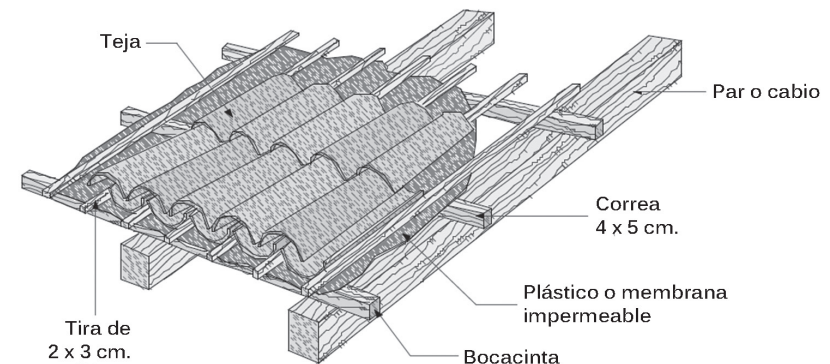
Detalle del armado de las correas en la estructura de cubierta.
